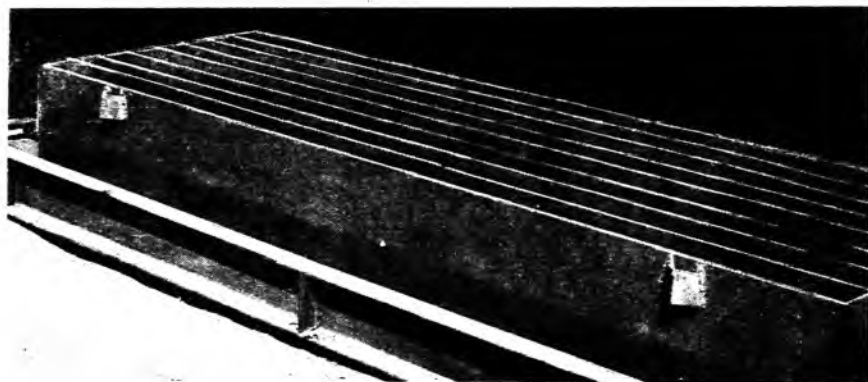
Кассетная веерная форма для изготовления крупногазмерных балочных конструкций
